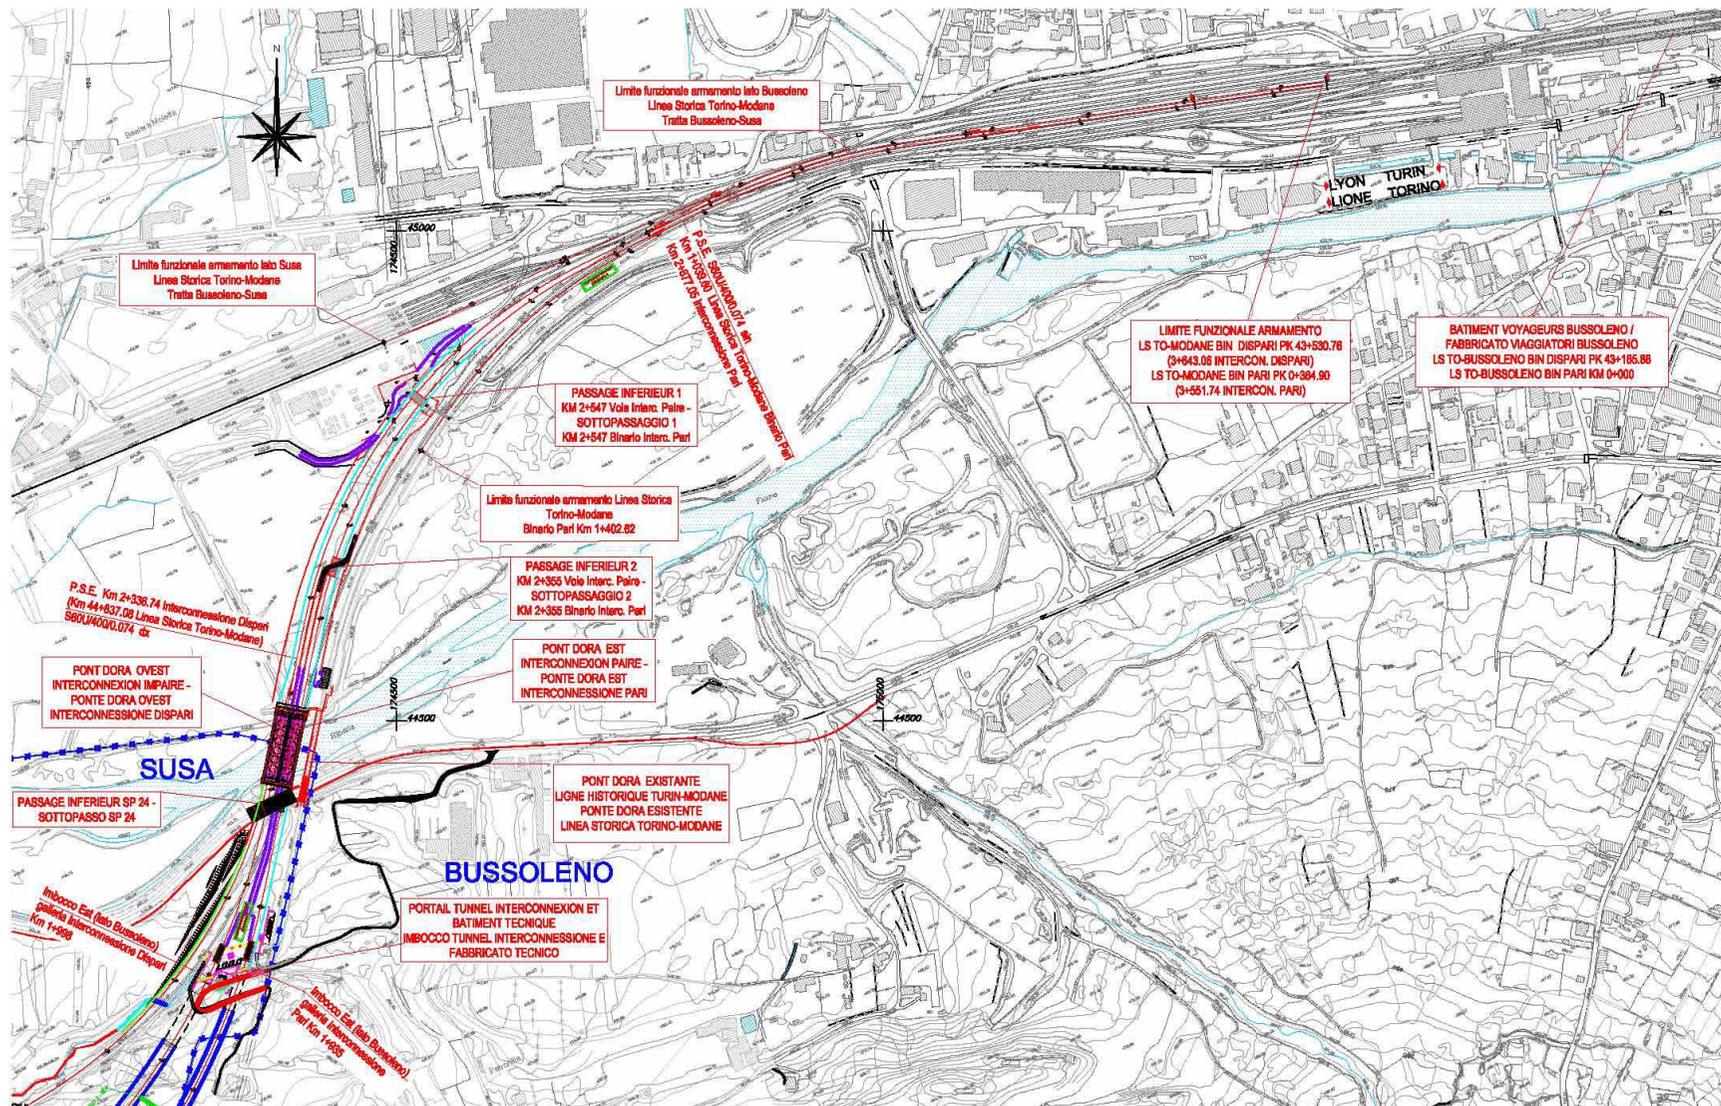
Planimetria tratto all'aperto interconnessione ed innesto nella stazione di Bussoleno
